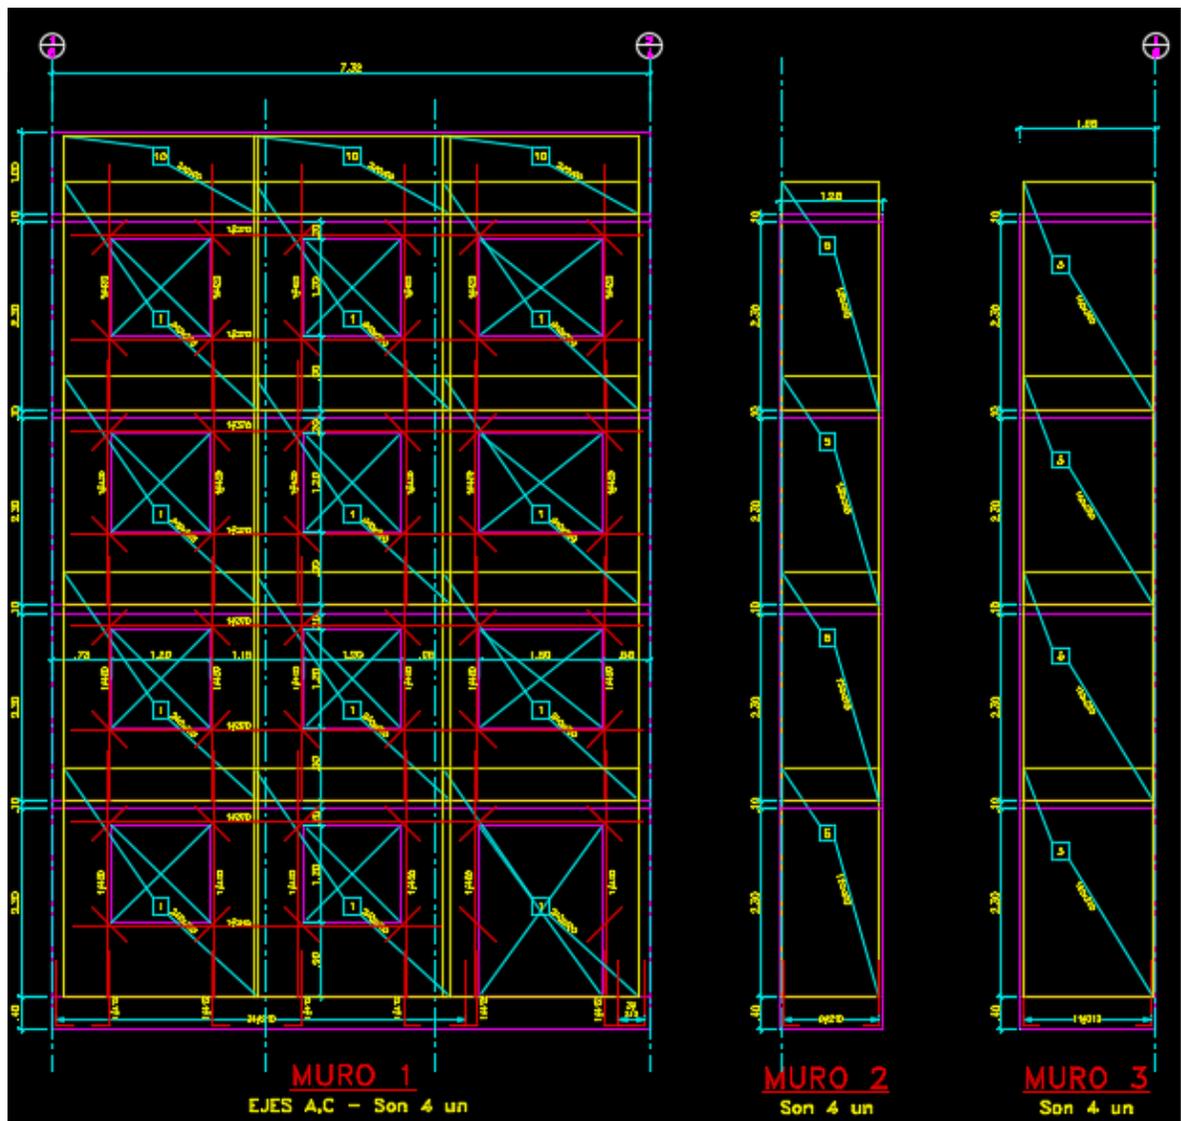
Plano de despiece de los muros 1, 2 y 3 (Fuente: Occiviles S.A)
